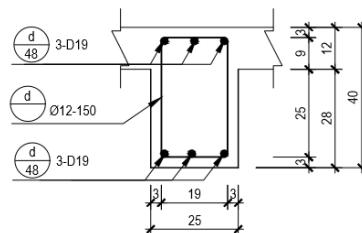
Detail Tulangan pada Balok B3 300x500
